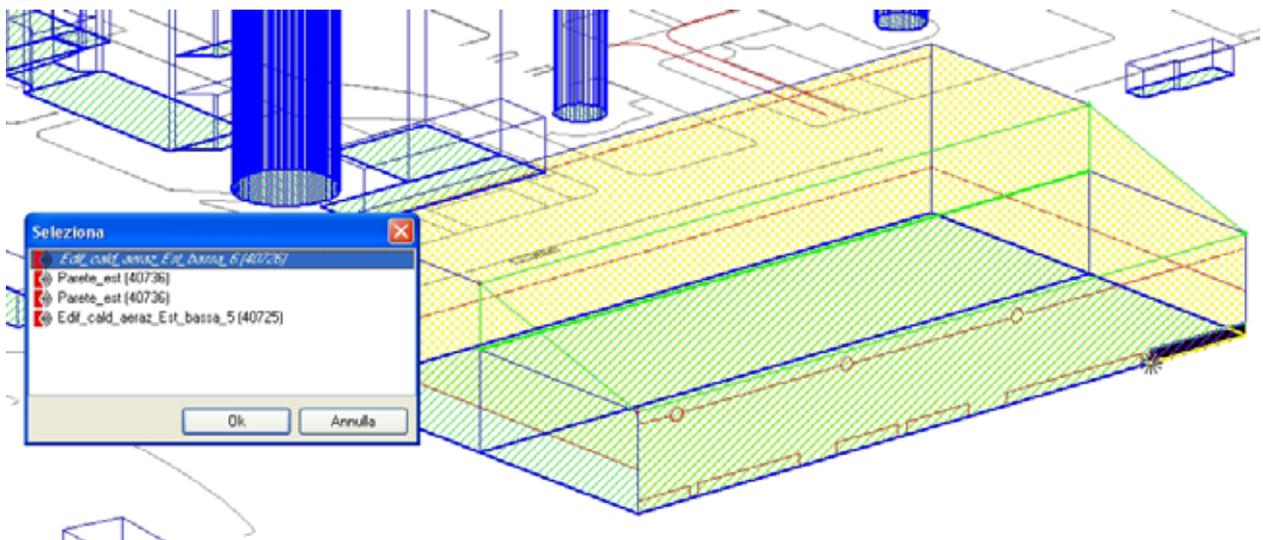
Nuovo edificio generatori di calore, porzione 6 ventilazione parete Est.
